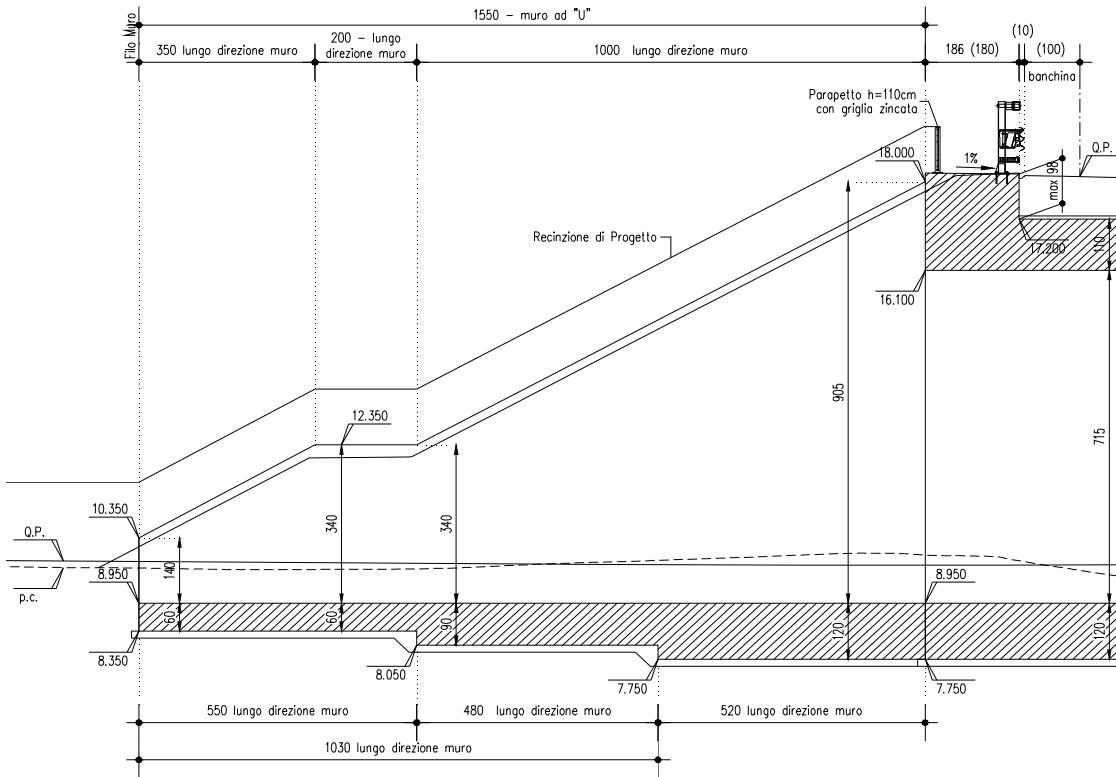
SEZIONE LONGITUDINALE MURI
